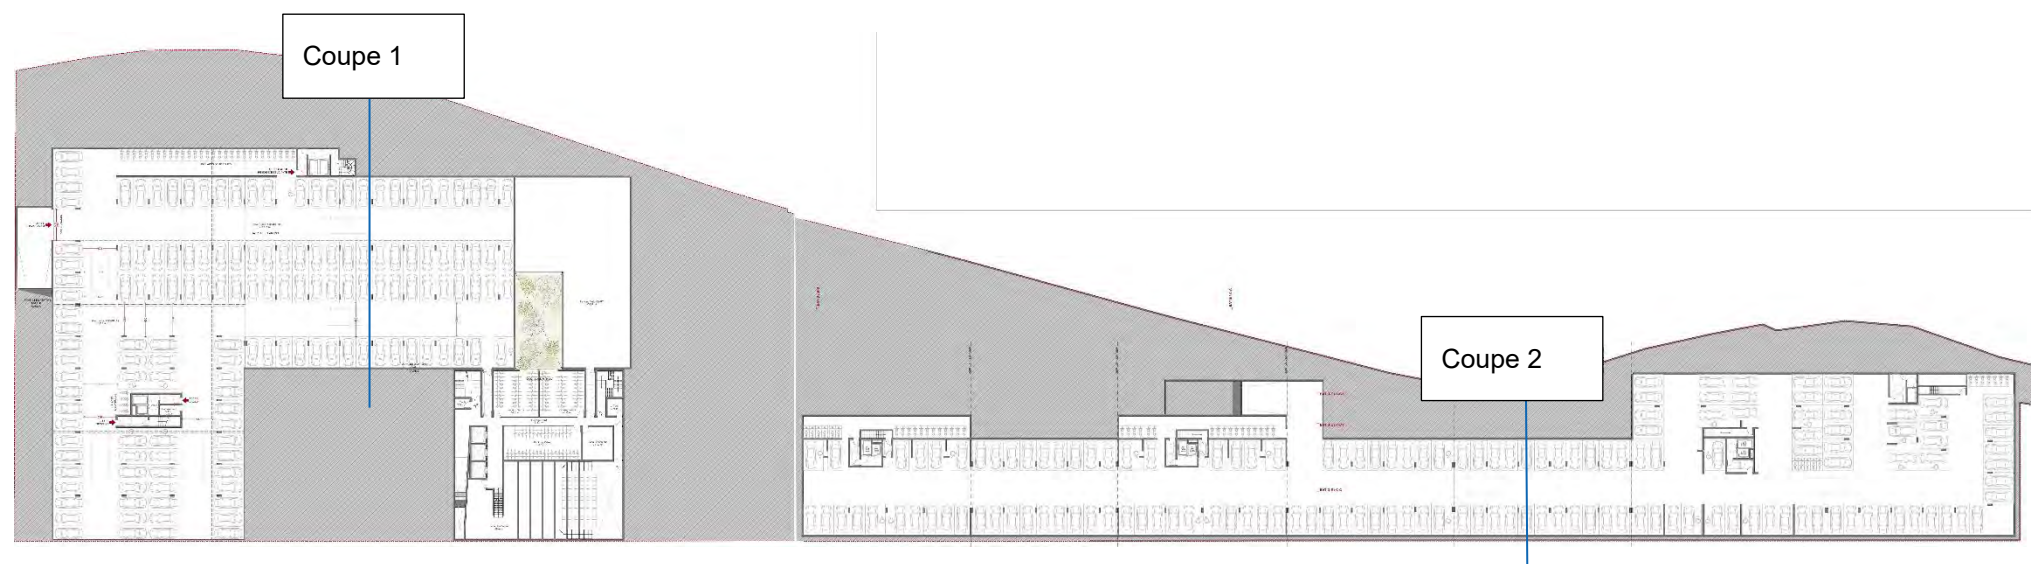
Plan du sous-sol du projet (source : ROUSSELLE. 20.02.2023)
